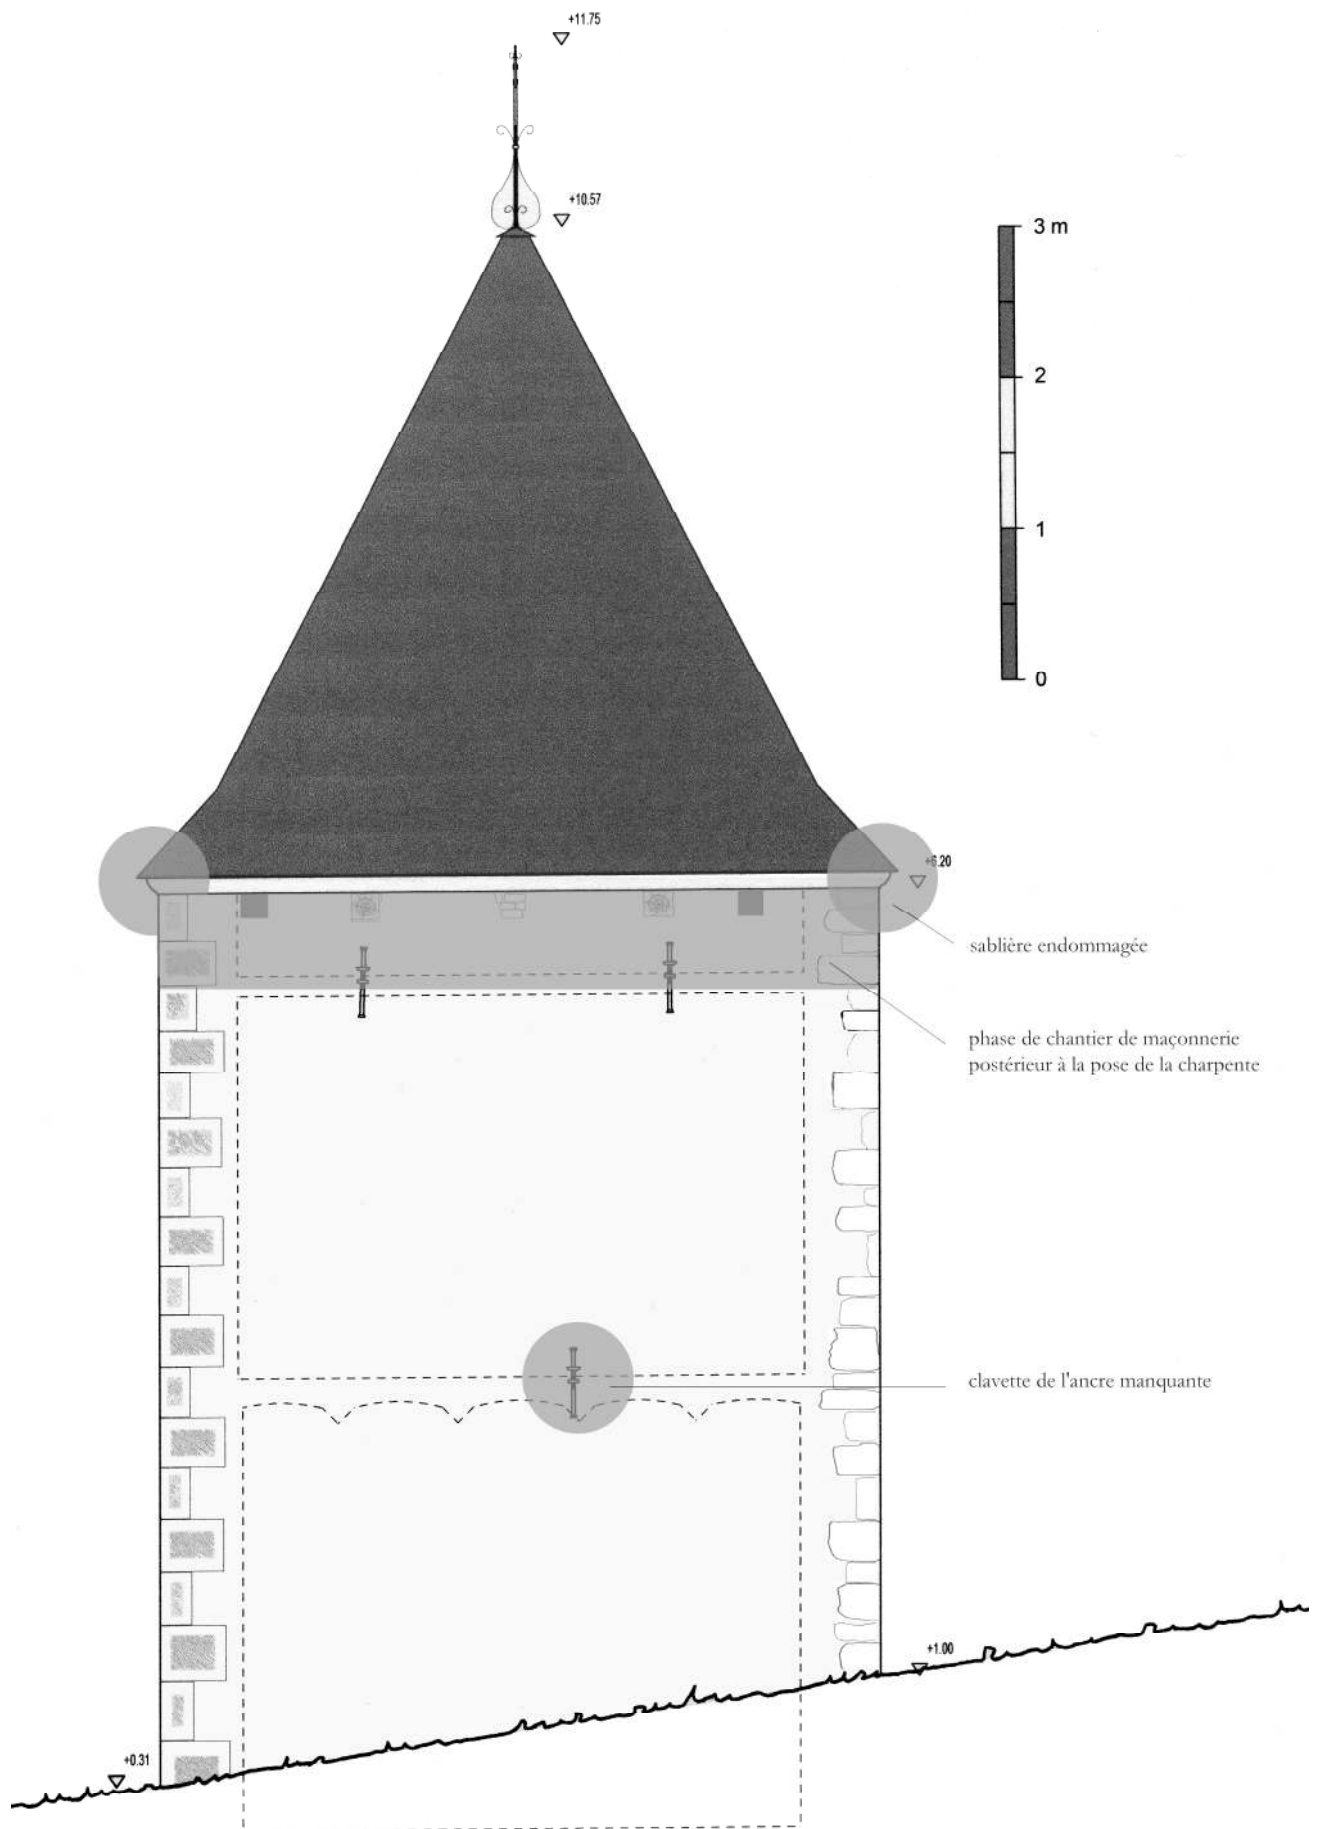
Pavillon. Elévation SO. Ech. 1/50°. Etat sanitaire. IG 2008.
